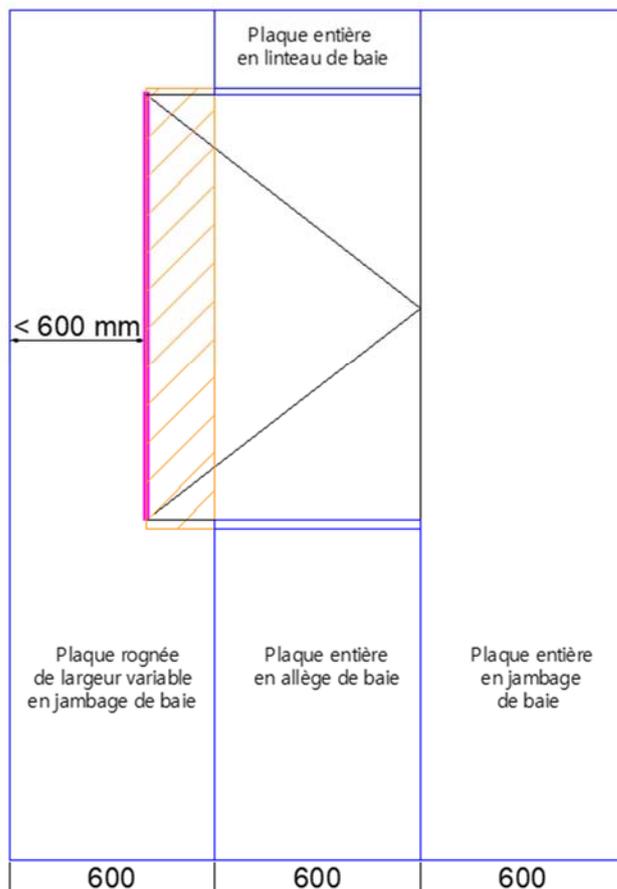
Encadrement d'une baie en tunnel avec plaque ajustée – Coupe Horizontale
